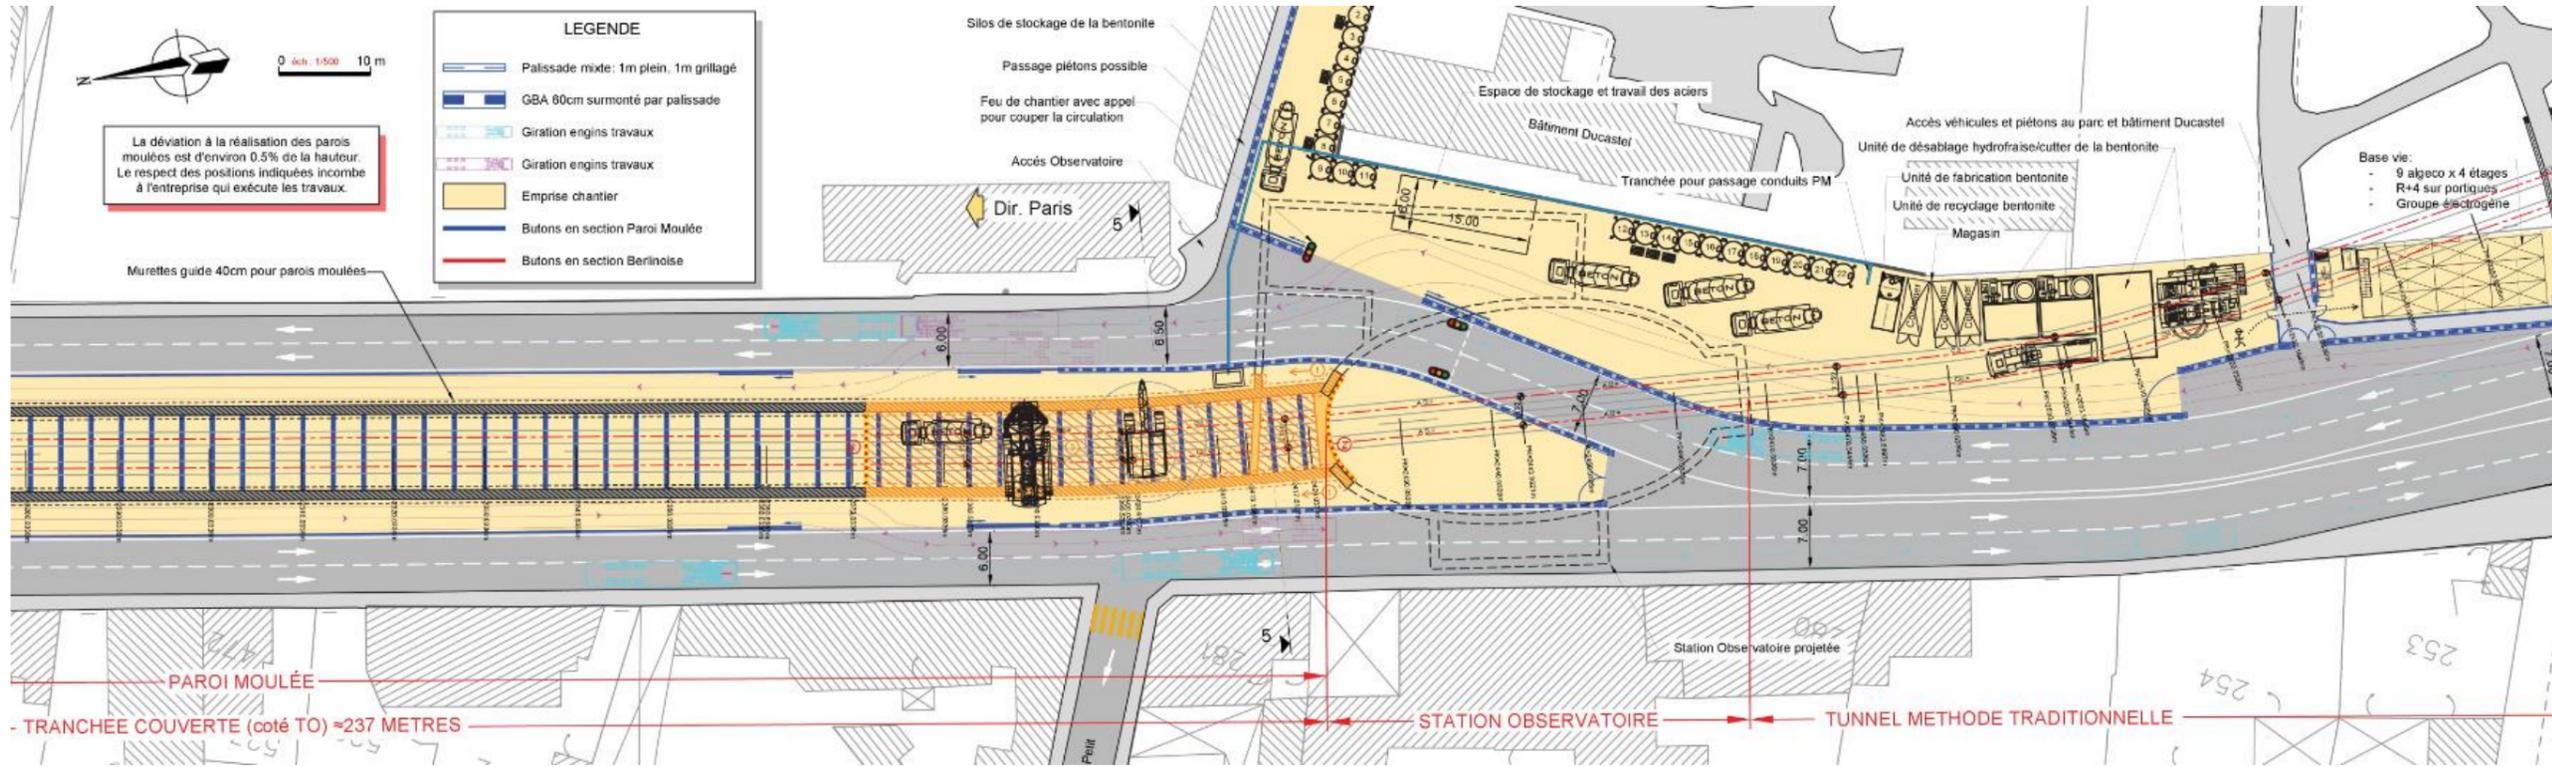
Vue en plan de l'emprise travaux le long de la RN7
